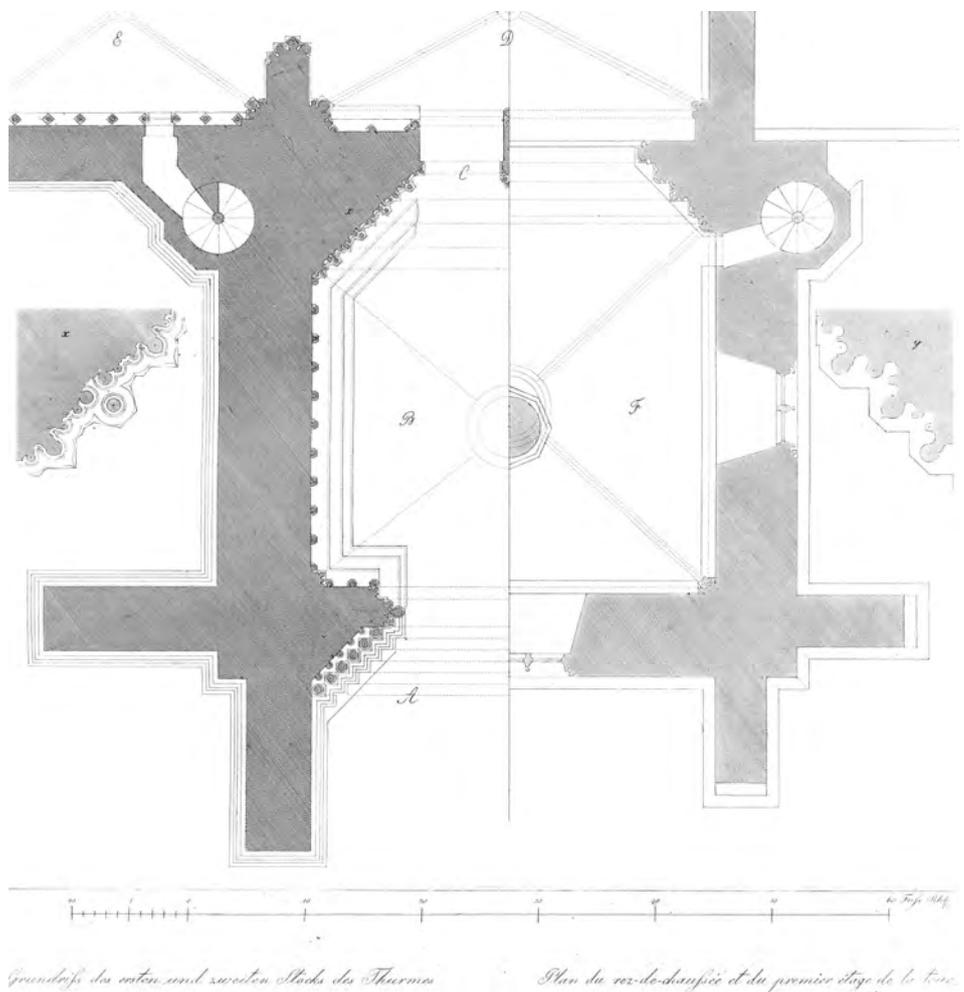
Grundriss Turmvorhalle und Michaelskapelle, Georg Moller 1830
